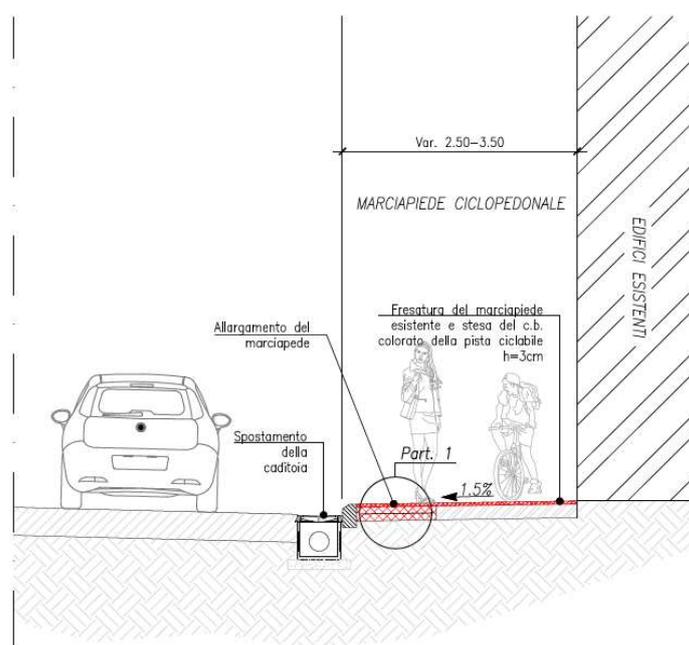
Sezione tipo 1: Pista ciclopedonale a quota marciapiede
